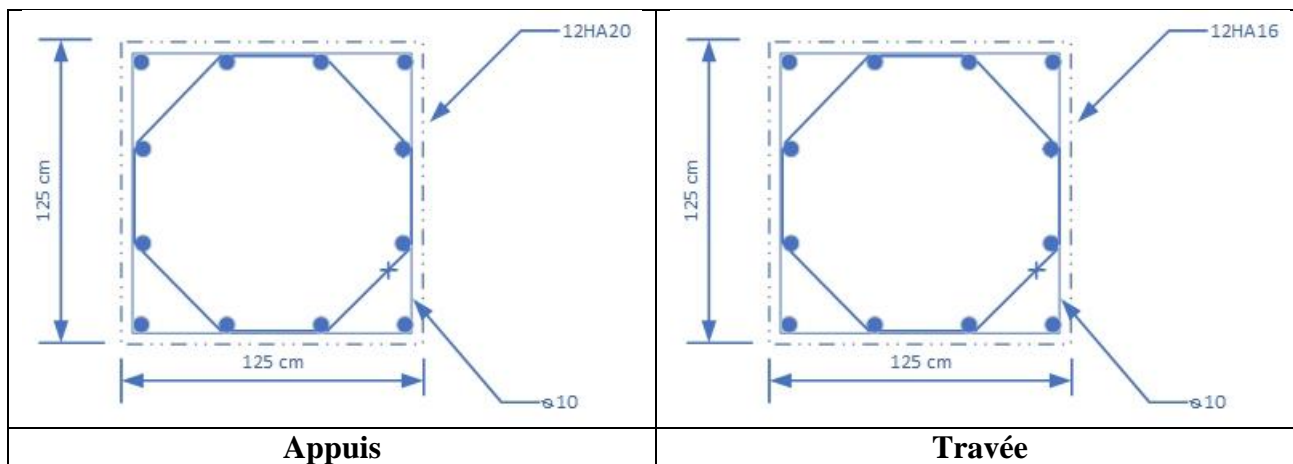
Ferrailage en travée et sur appuis de nervure
